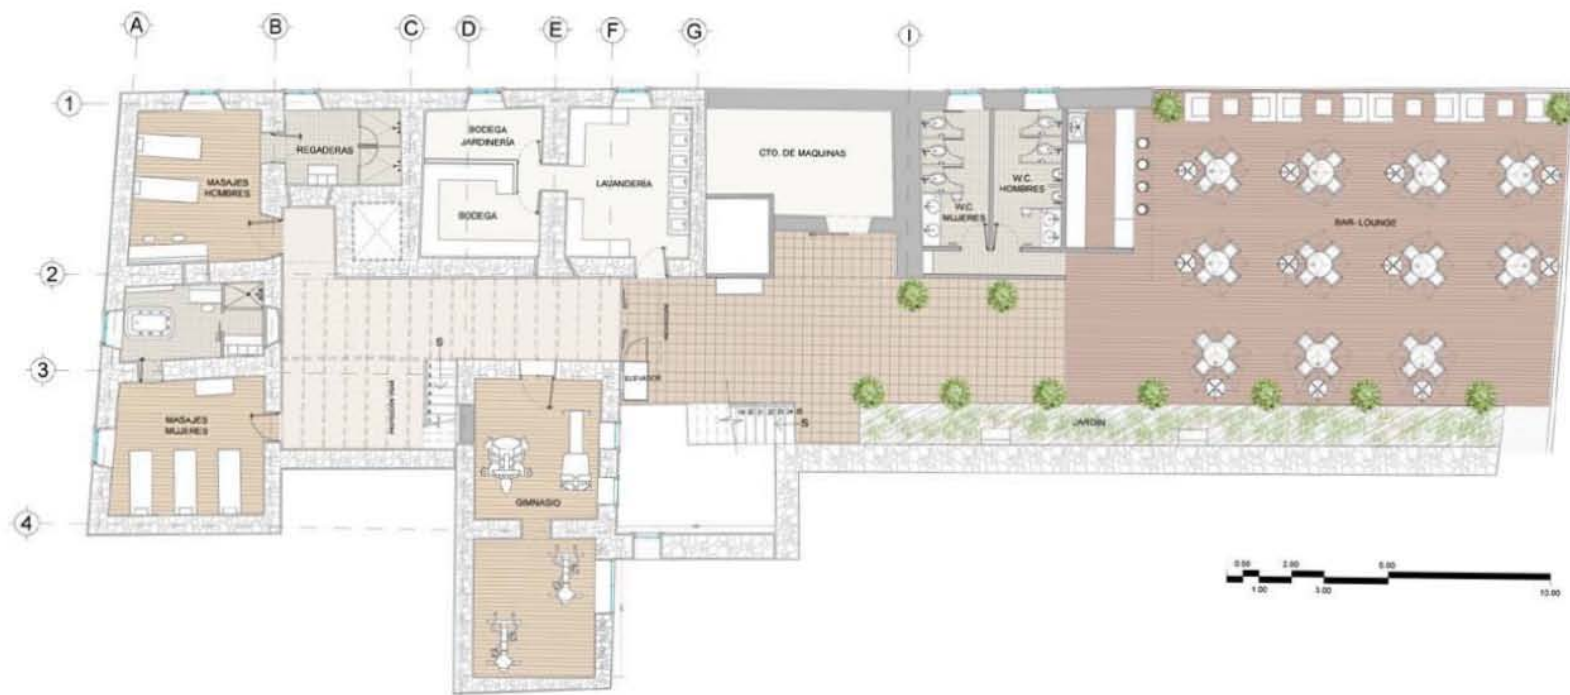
Planta de sótano del proyecto de adecuación del "Hotel del Jardín". Spa, bar, gimnasio y servicios.
